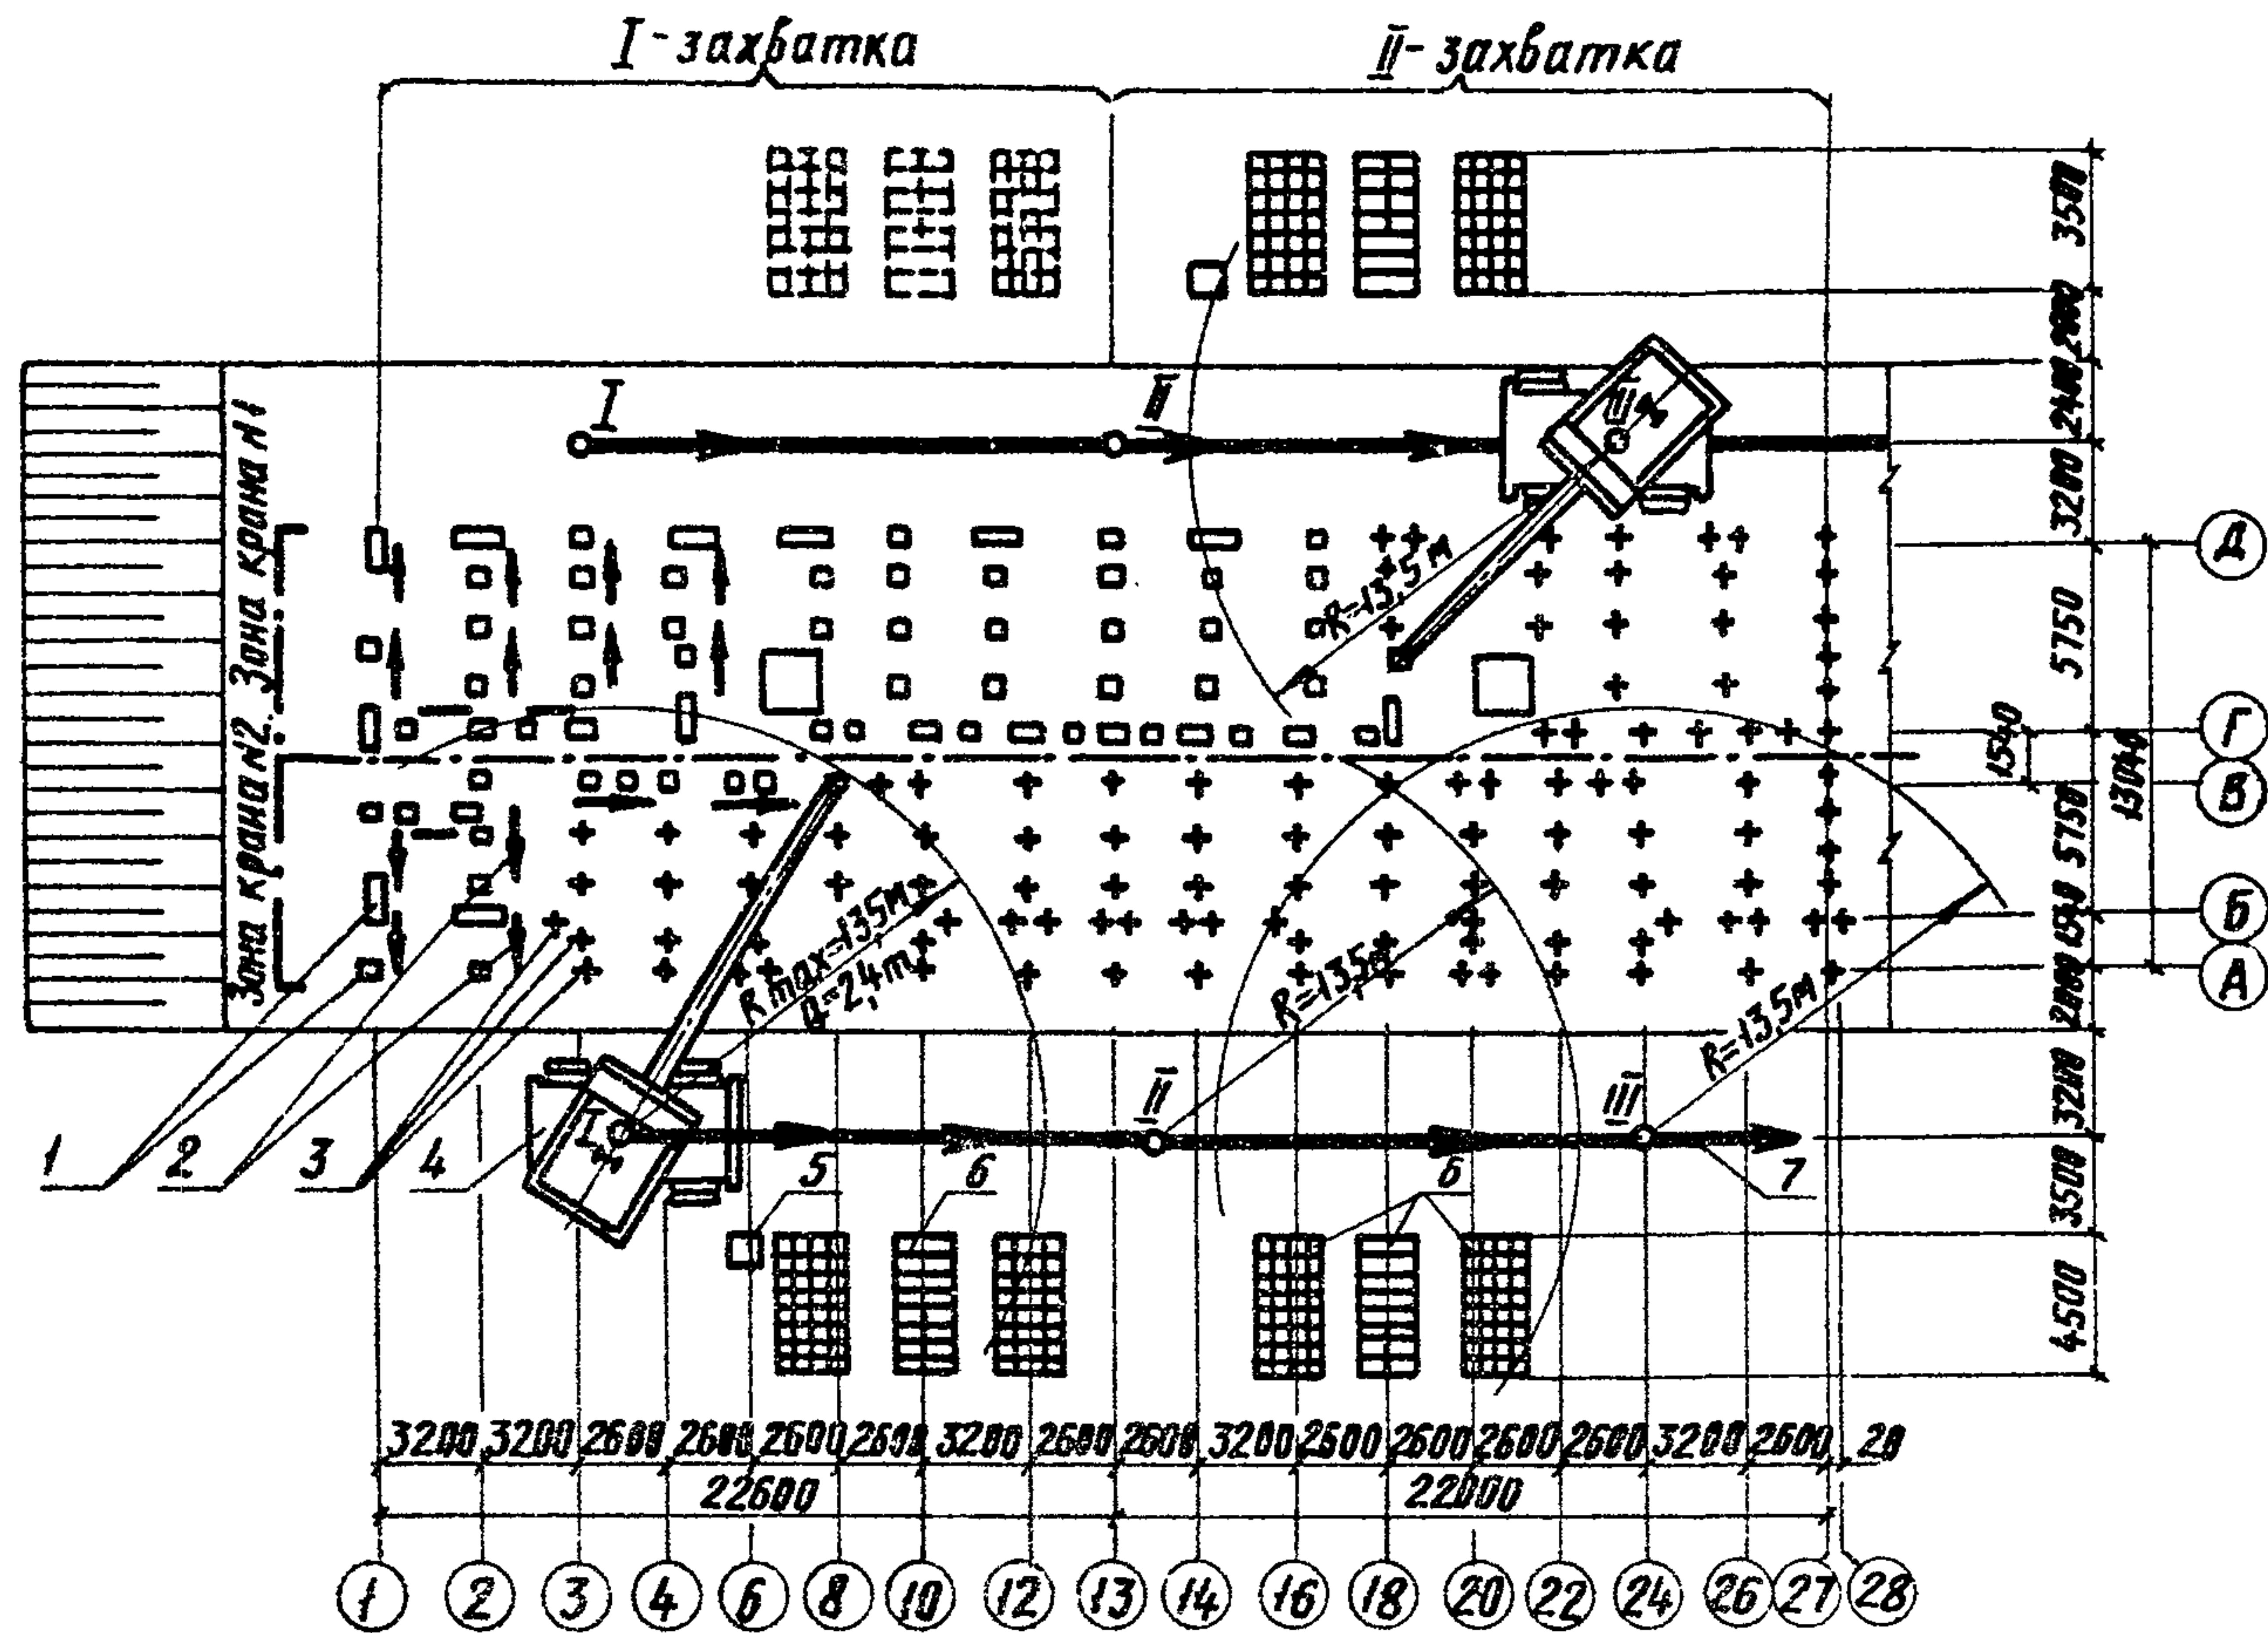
Схема организации работ по монтажу оголовков: 1-смонтированные оголовки; 2-правление монтажа; 3-забивные сваи; 4-инвенторесный кран К-161; 5-ящики для приска бетона; 6-стабелия оголовков; 7-ось движение крана; I, II, III-стоянки крана
